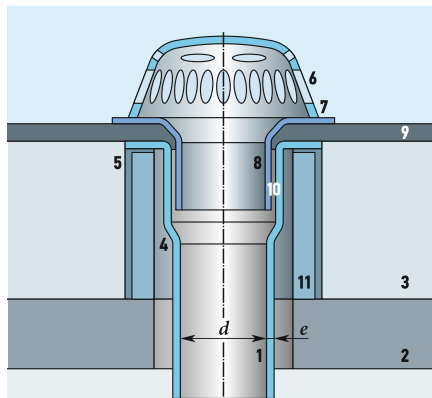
Водосточная воронка из пластмассы (1 — сливной патрубок; 2 — железобетонная плита перекрытия; 3 — теплоизоляция; 4 — раструб; 5 и 7 — отбортовки; 6 — купол; 8 — патрубок; 9 — кровельный ковёр; 10 — тугоплавкий битум; 11 — асбестоцементная труба; d и e — наружный диаметр и толщина стенки)
